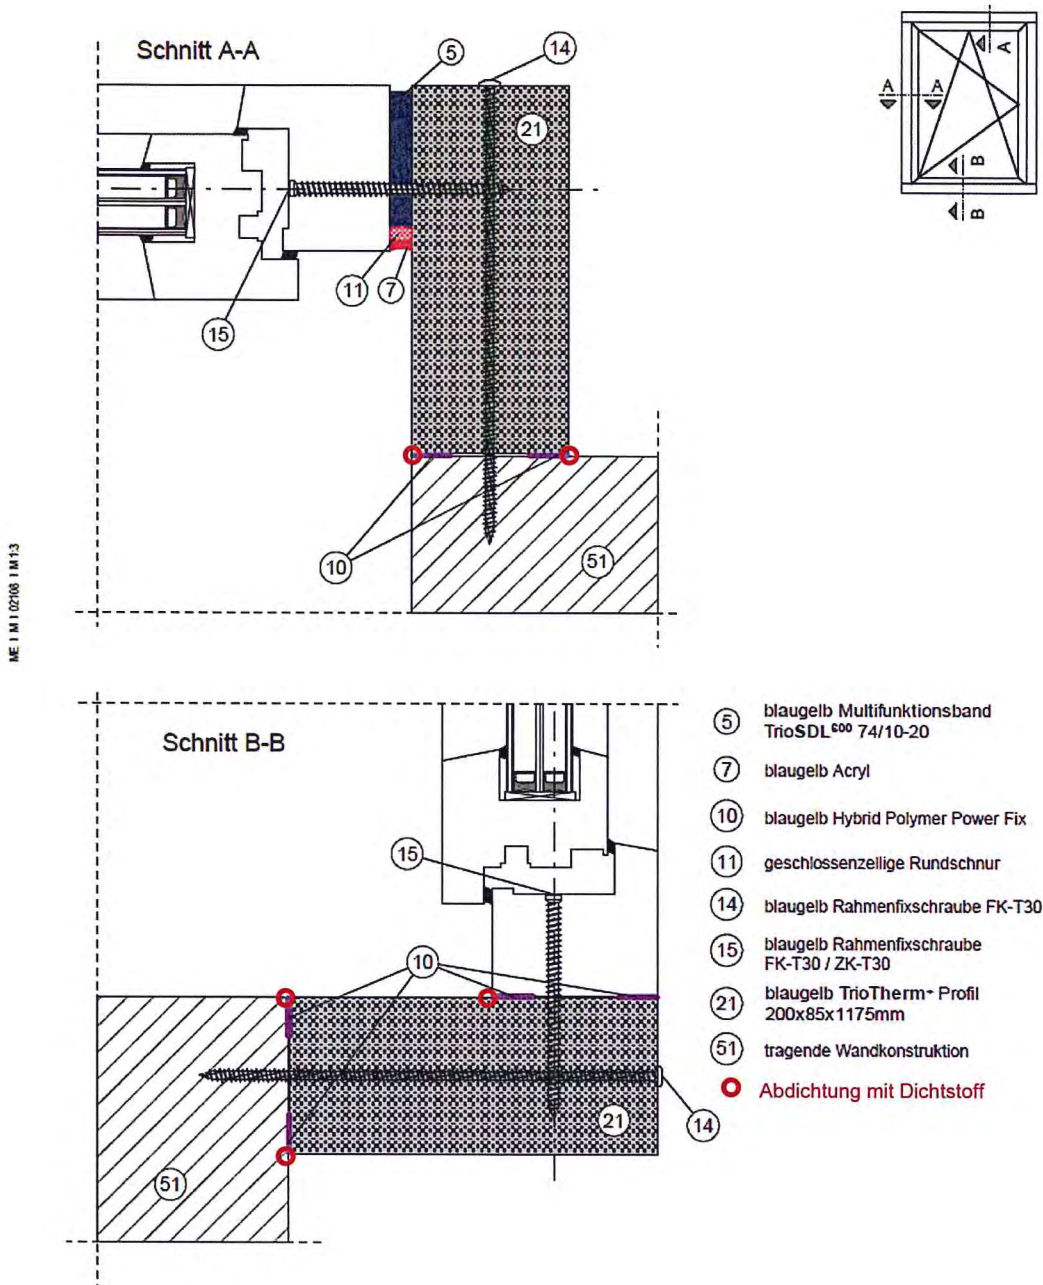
Schnittzeichnung des Herstellers, Anschlussvariante 2 ohne Leibungsverkleidung (Option Leibungsverkleidung analog Bild 2), Grundsatzdetail: Zargenprofil außen und innen mit Dichtstoff zum Prüfstand abgedichtet, Fensterrahmen unten innen mit Dichtstoff zur Zarge abgedichtet.
